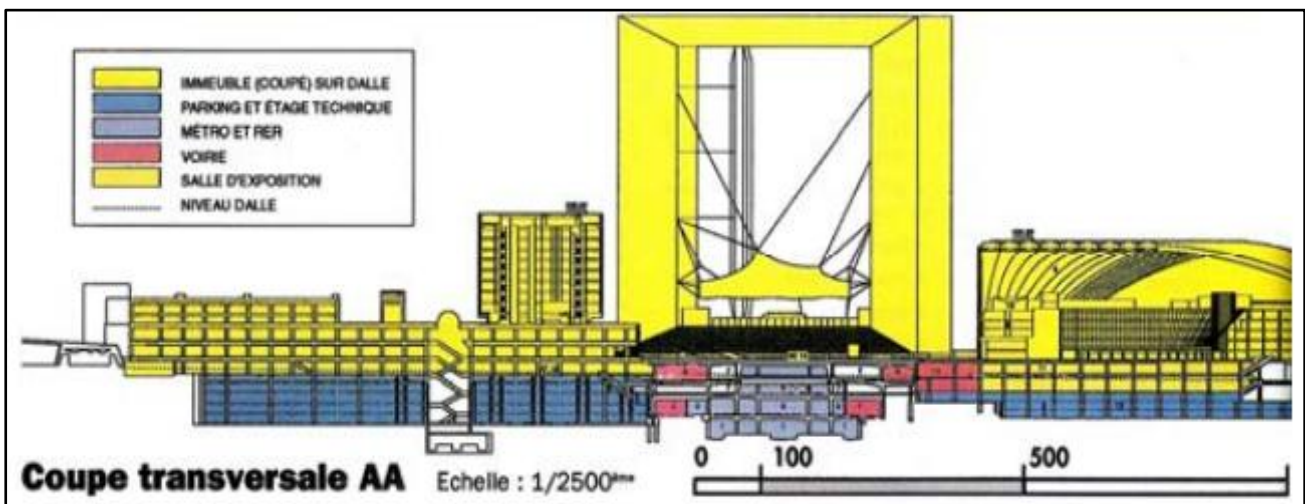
Coupe transversale de la dalle devant la Grande Arche,
